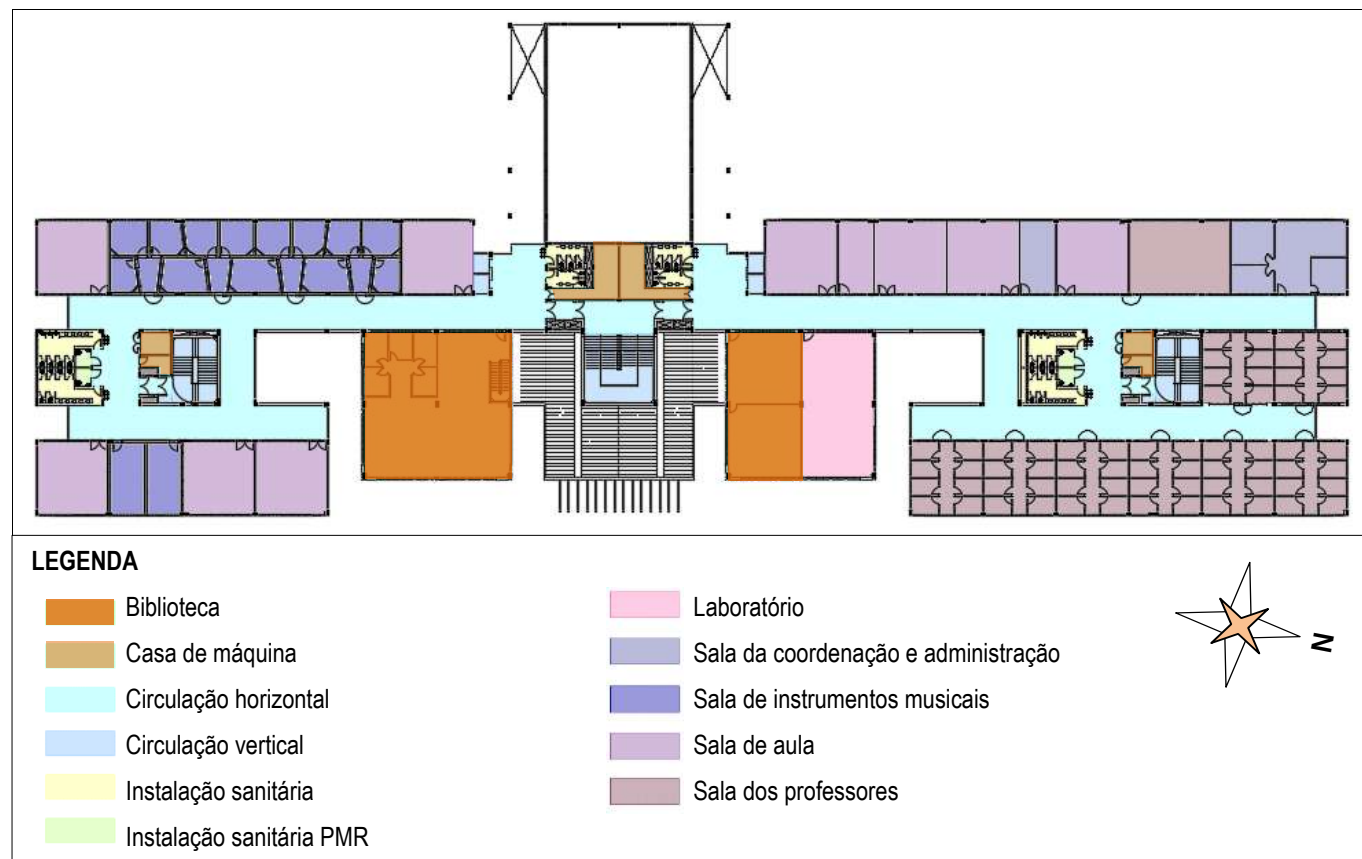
Planta setorizada do segundo pavimento do bloco 07.
